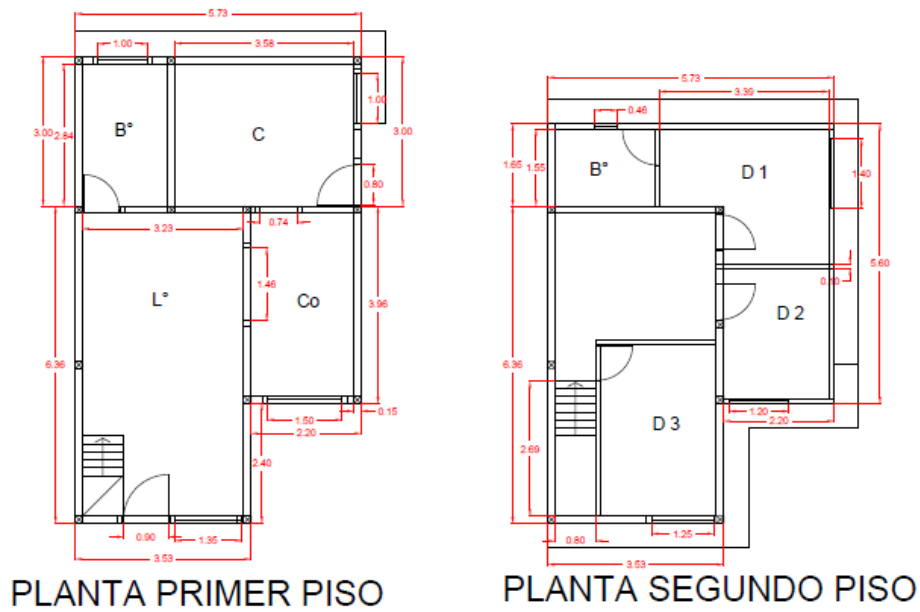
Planos de planta con rectificación de medidas en terreno – Fuente: Elaboración propia
